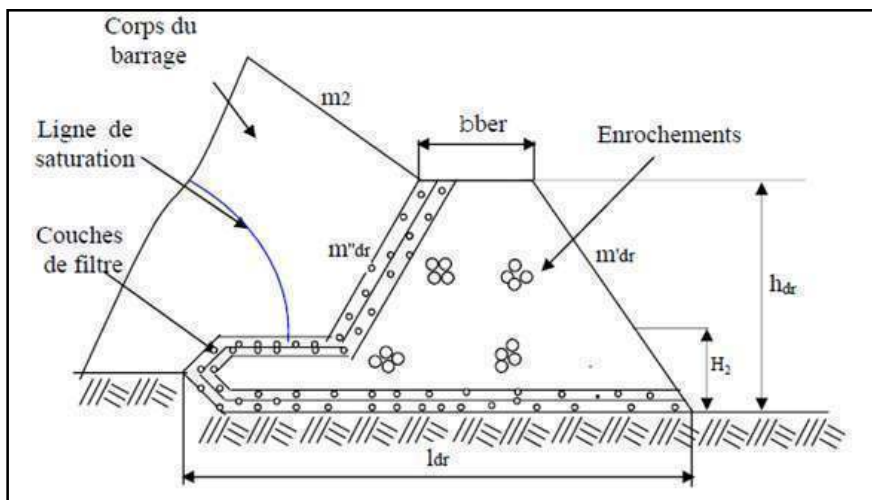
Prisme de drainage avec un tapis interne sur fondations perméables.
